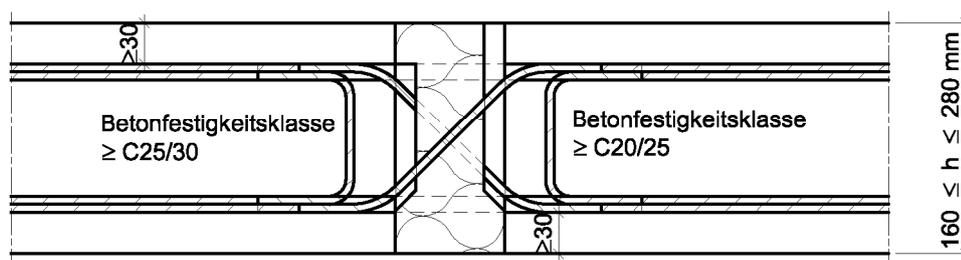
Beispiel Schöck Isokorb Typ D mit Aufhängebewehrung
